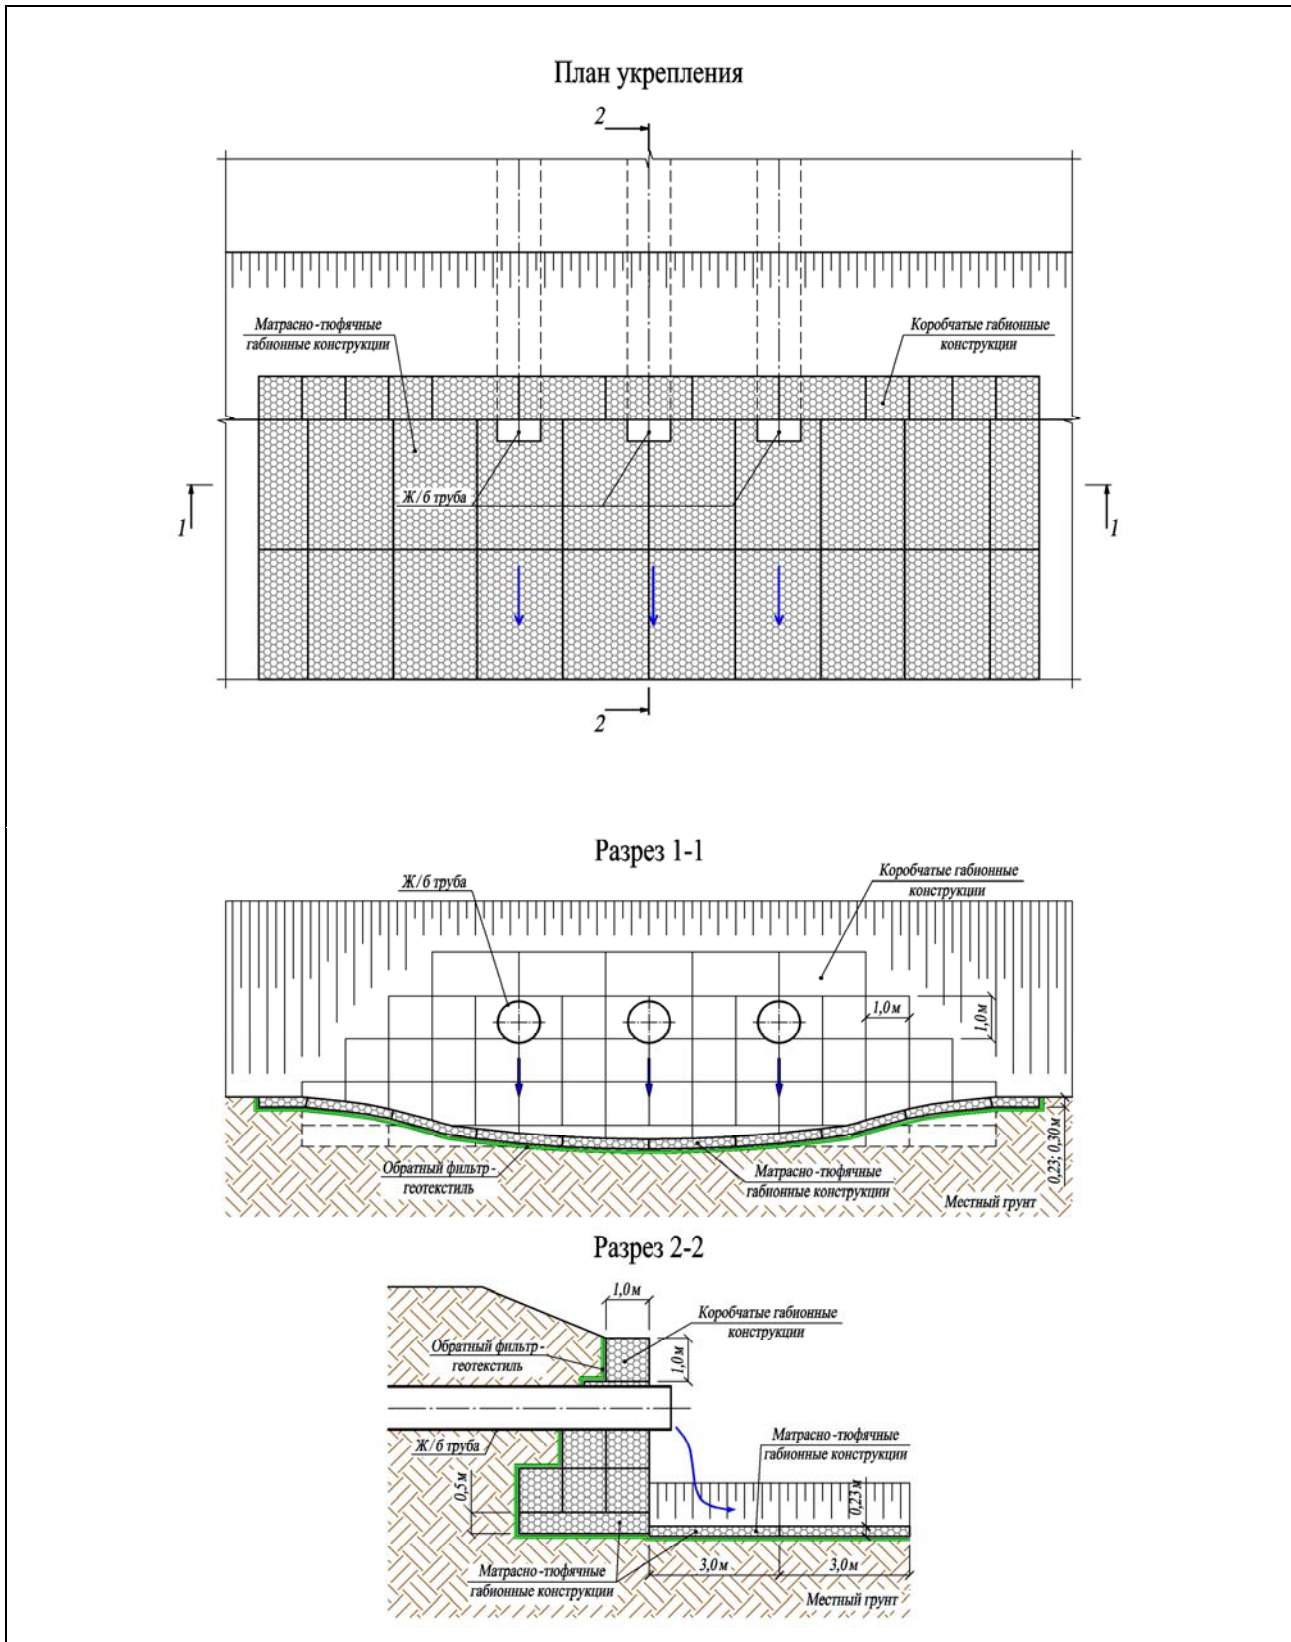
Укрепление оголовков водопропускных труб габионными конструкциями
